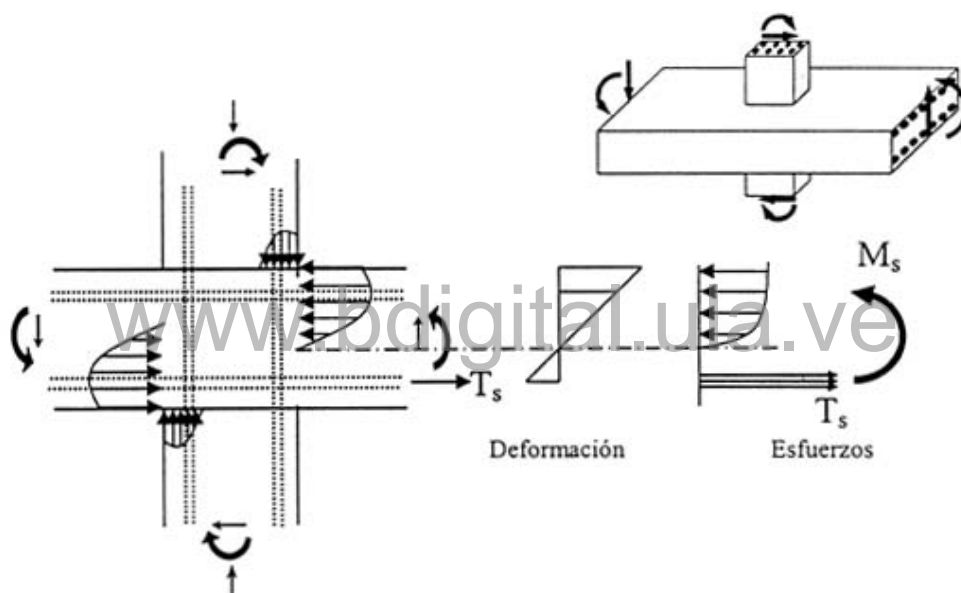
Distribución de esfuerzo y deformación en la sección transversal de una viga plana con deslizamiento del refuerzo en la junta
